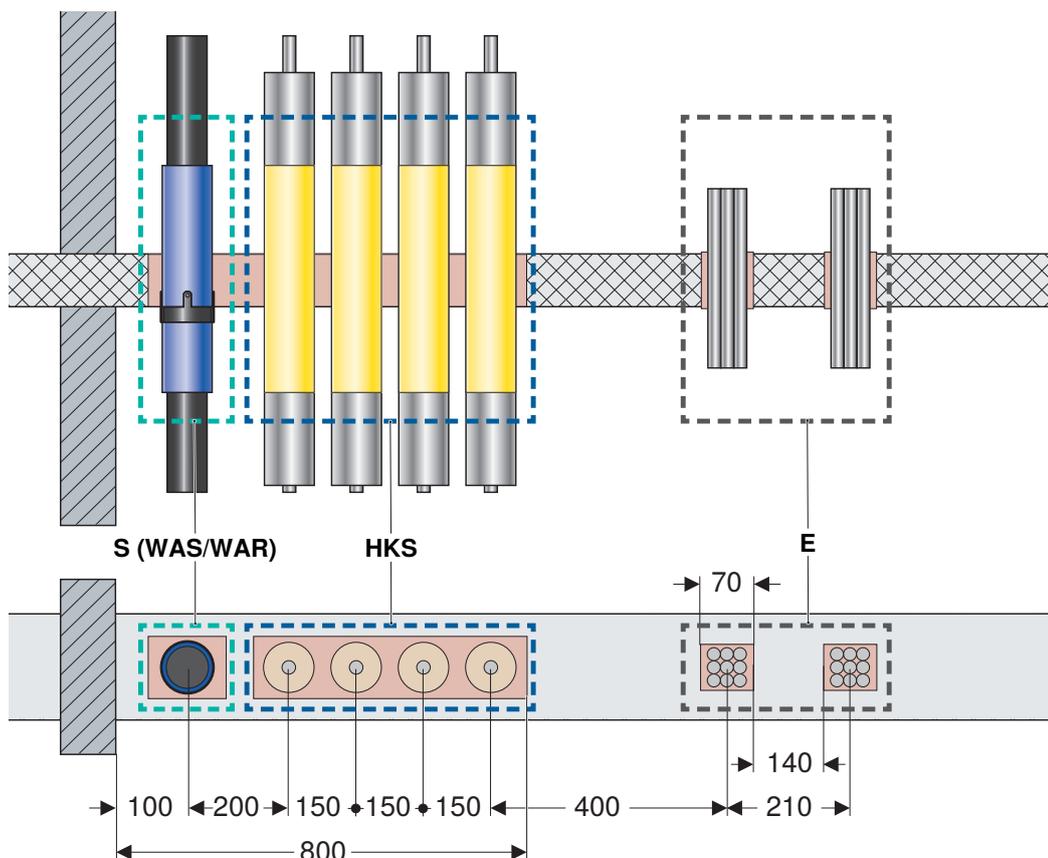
Steigzone für alle Gebäudearten und Bauhöhen, mit Verwendung der Geberit Brandschutzmanschette
